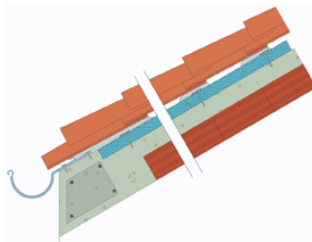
Detalle constructivo para el faldón formado por forjado inclinado.
